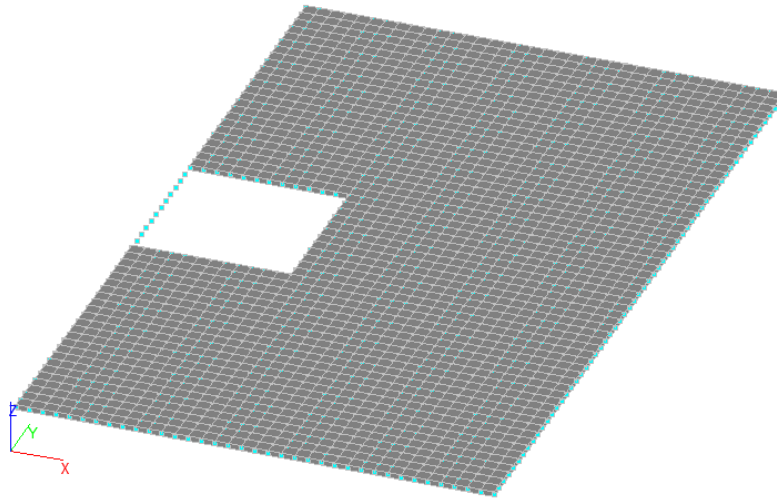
Расчетная схема монолитного безбалочного перекрытия
